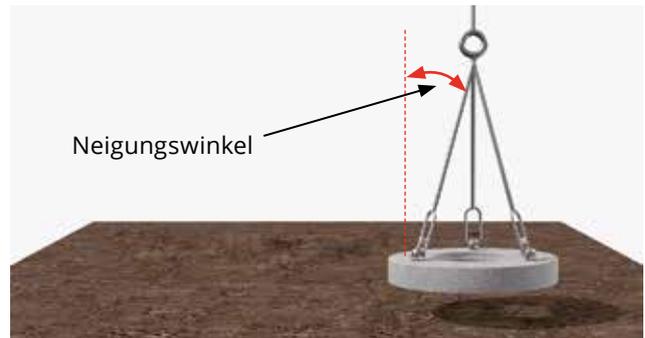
| Stahlbetonabdeckplatte, angeschlagen Neigungswinkel
